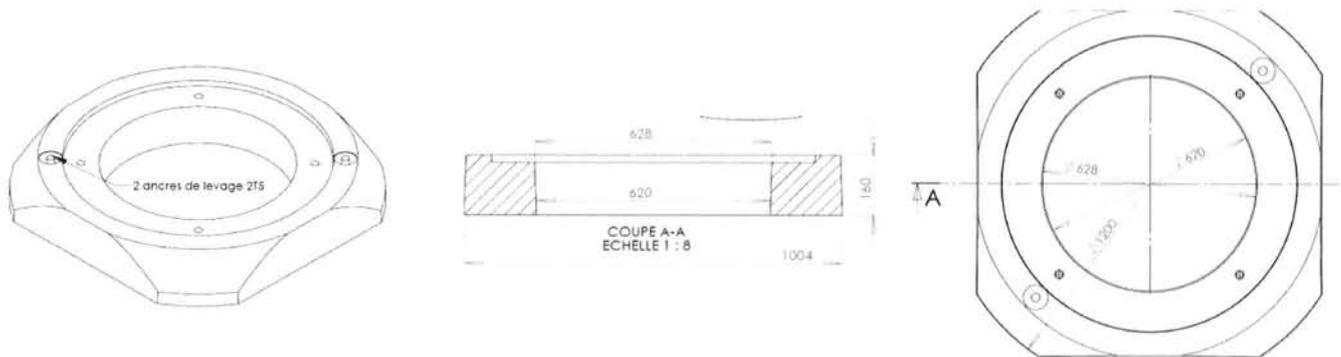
Vues en plan et en coupe de la dalle de répartition
